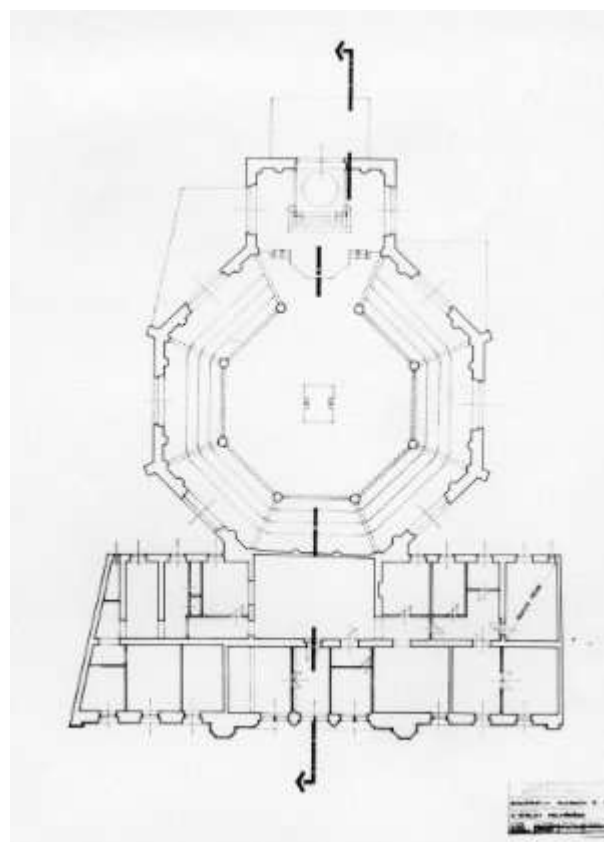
Grundriss 2. Obergeschoß 1971 Vermesserplan 1971
